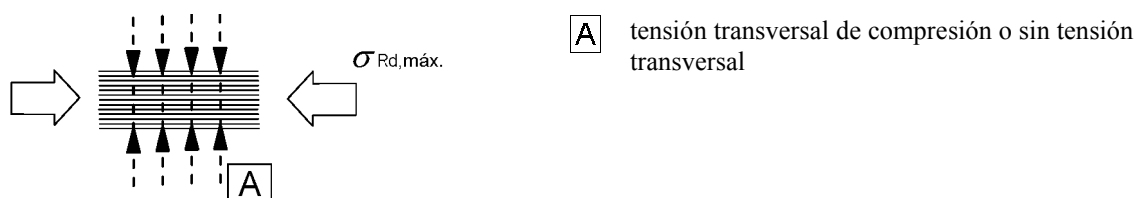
Resistencia de cálculo de las bielas de hormigón sin tracción transversal
